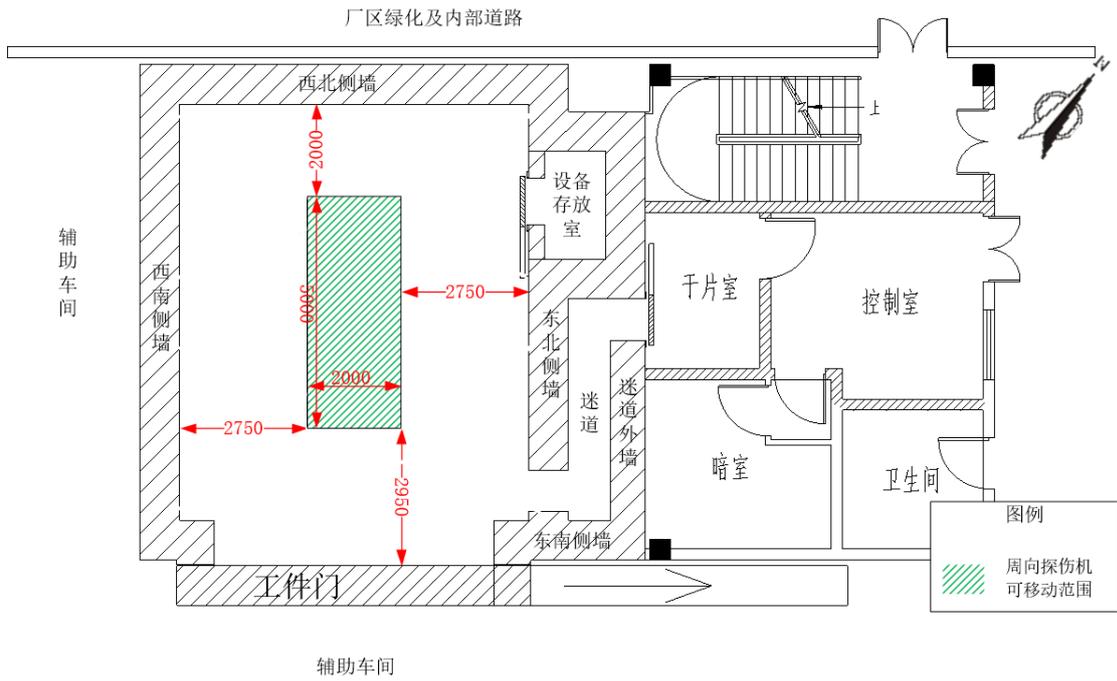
探伤室周向探伤机可移动范围示意图（平面图）
